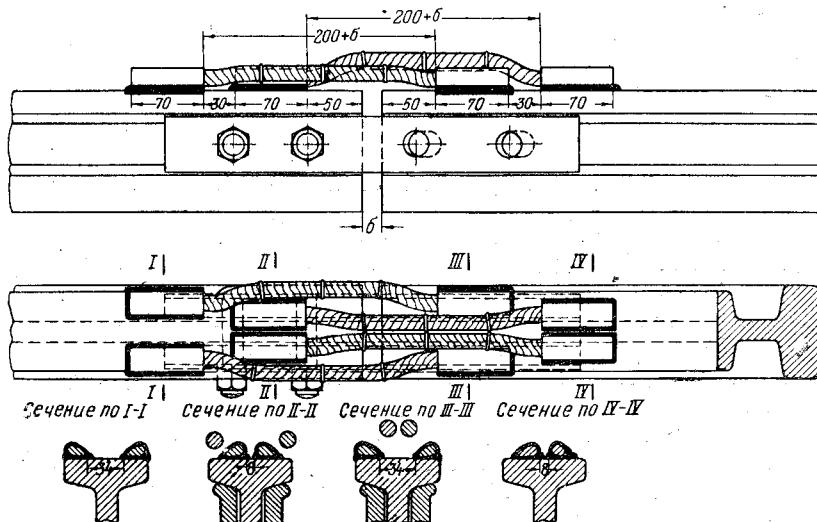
Стык между сварными пletями контактных рельсов
